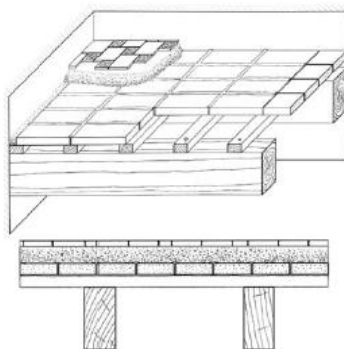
Axonometría y sección de un forjado de rasillas tipo (Diodato, 2009).
